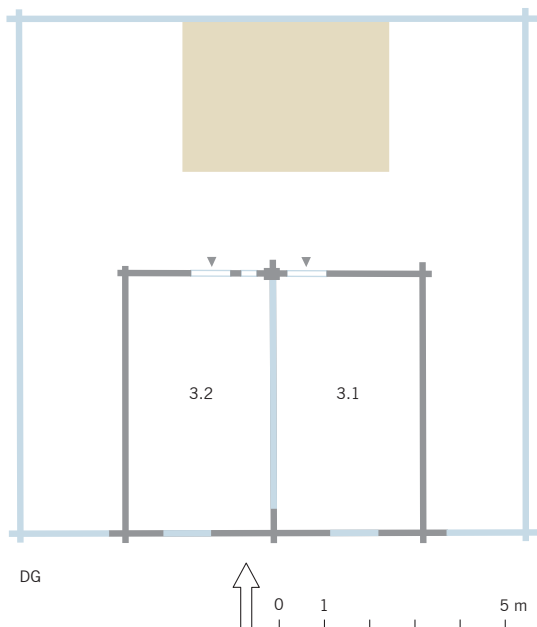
Eggstrasse 57 in Oberägeri, Grundriss des Dachgeschosses.
